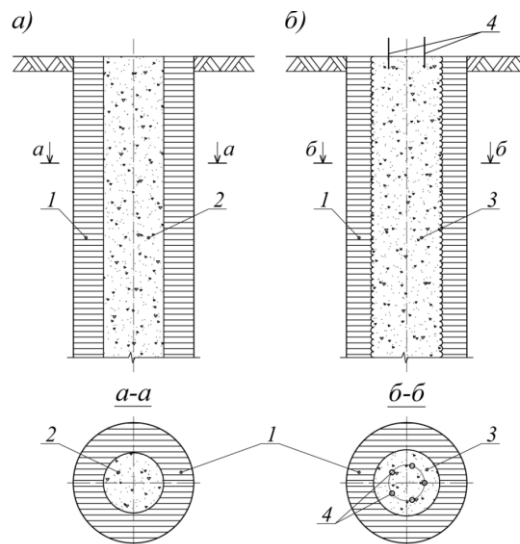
Схема устройства грунтобетонной сваи (ГБС).
